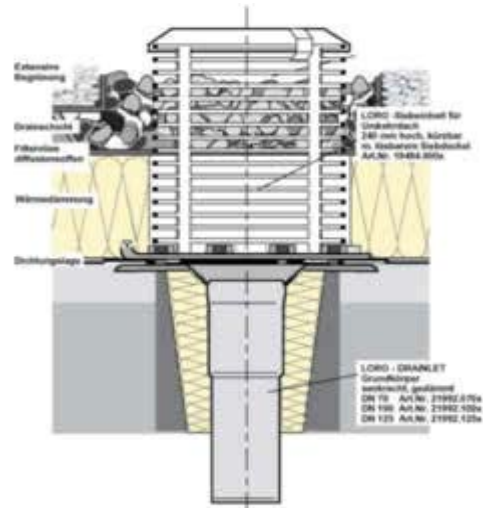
Dachablauf für Einbau in ein Umkehrdach; in die Siebeinheit ist ein abnehmbarer Siebdeckel für Wartungszwecke integriert
